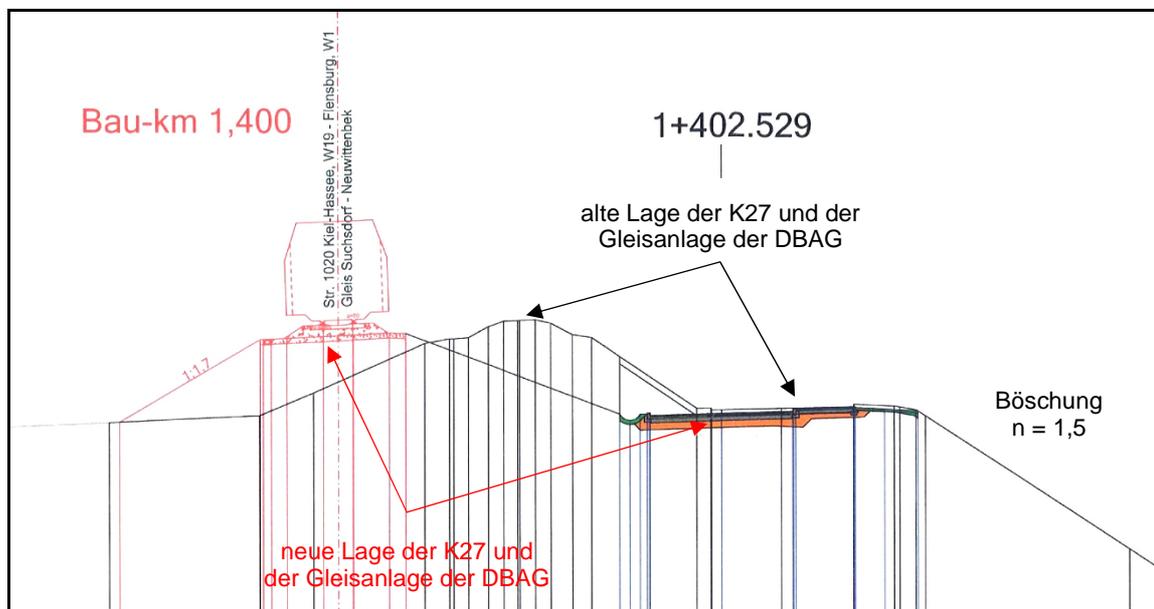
Verkehrsplanung, Querprofil Bau-km 1+400 - Variante 5.4a (Quelle: eds-planung)
